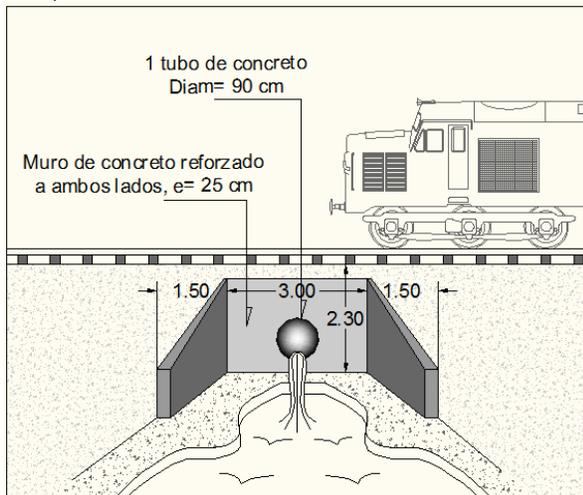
Detalle de obra complementaria #28, (Fuente: Autor)
